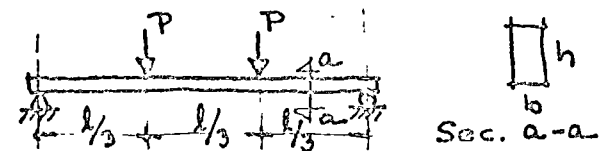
Viga rectangular libremente apoyada, con dos cargas concentradas
